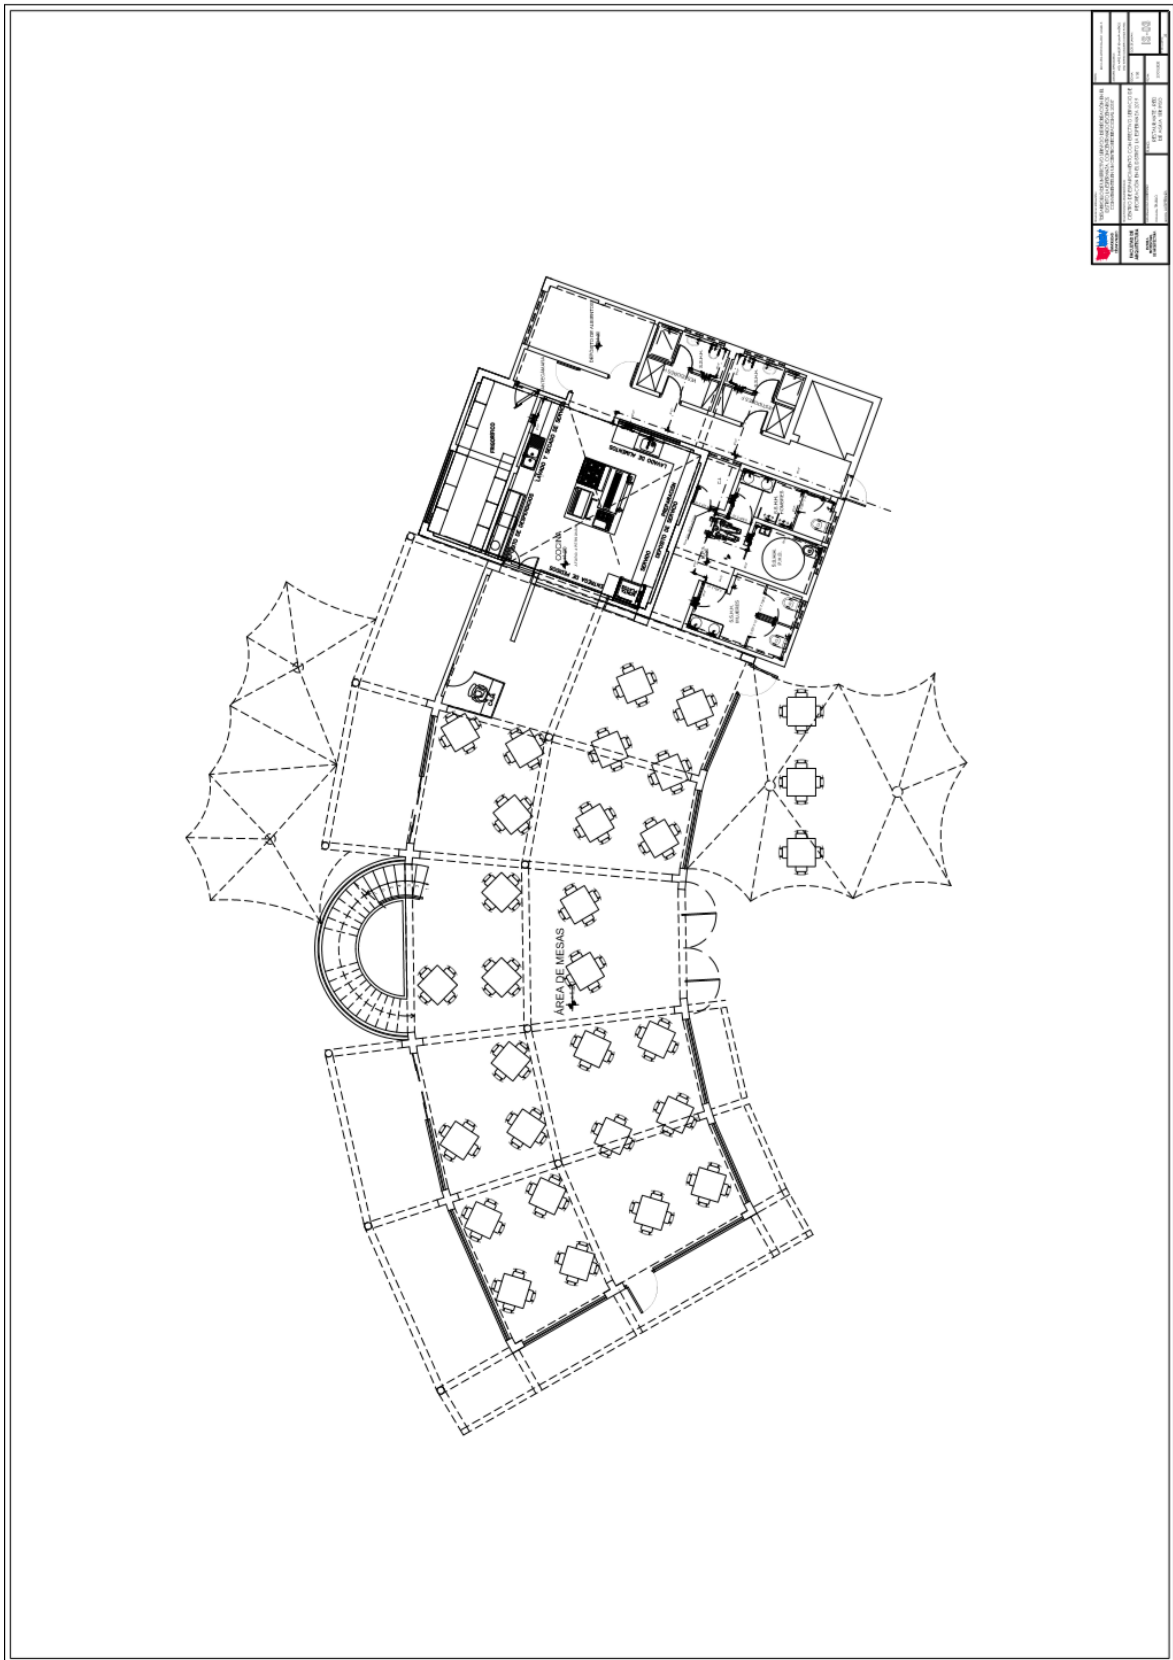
Plano de Agua Restaurante 1er piso. Elaboración propia.
